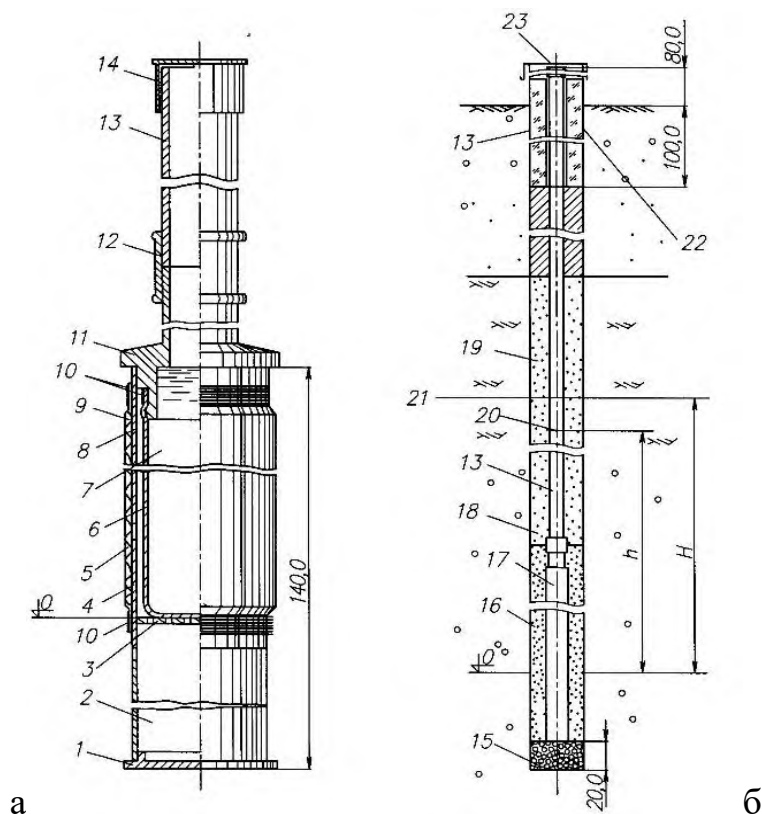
Незамерзающий скважинный пьезометр [44]: а – общий вид
